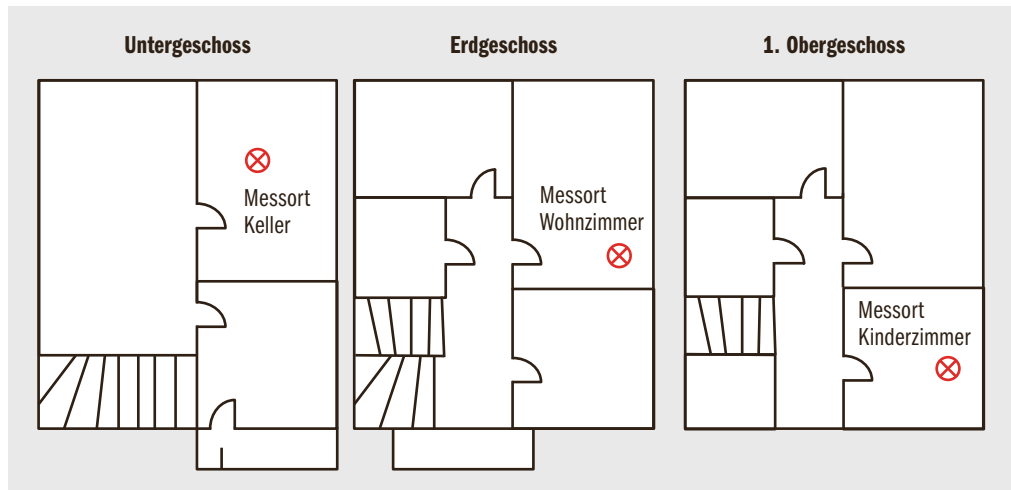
Grundrisse mit den drei Messpunkten.
